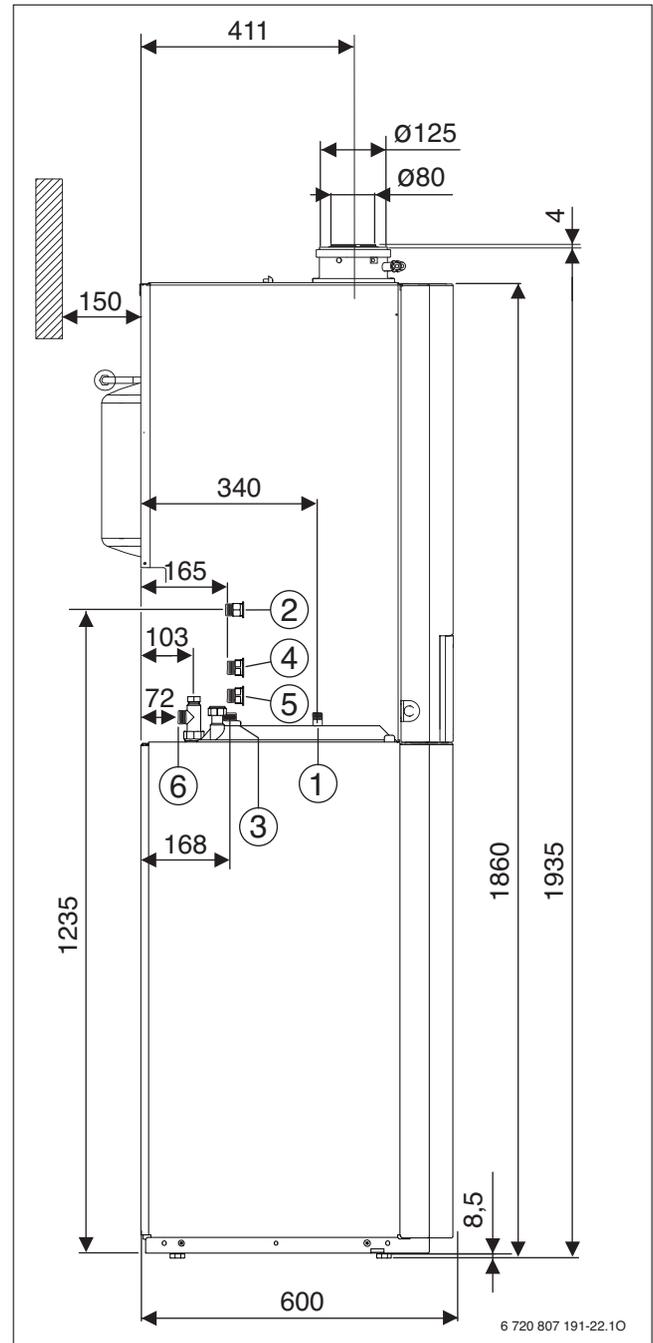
Abmessungen und Anschlüsse für GB172-.. T210SR V2 ohne Anschluss-Set (Maße in mm)
